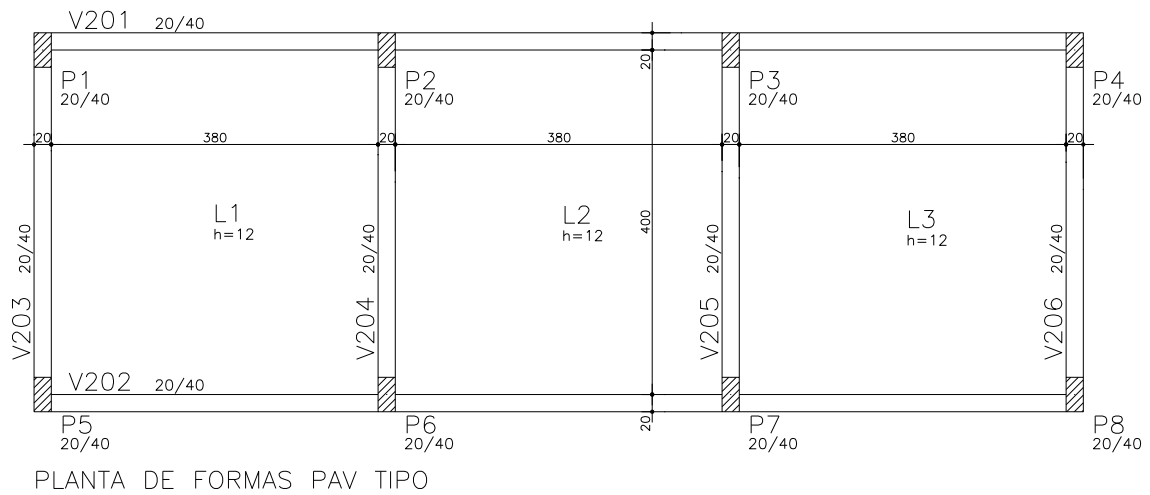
Planta de formas do pavimento tipo: T1 -4P1V1
